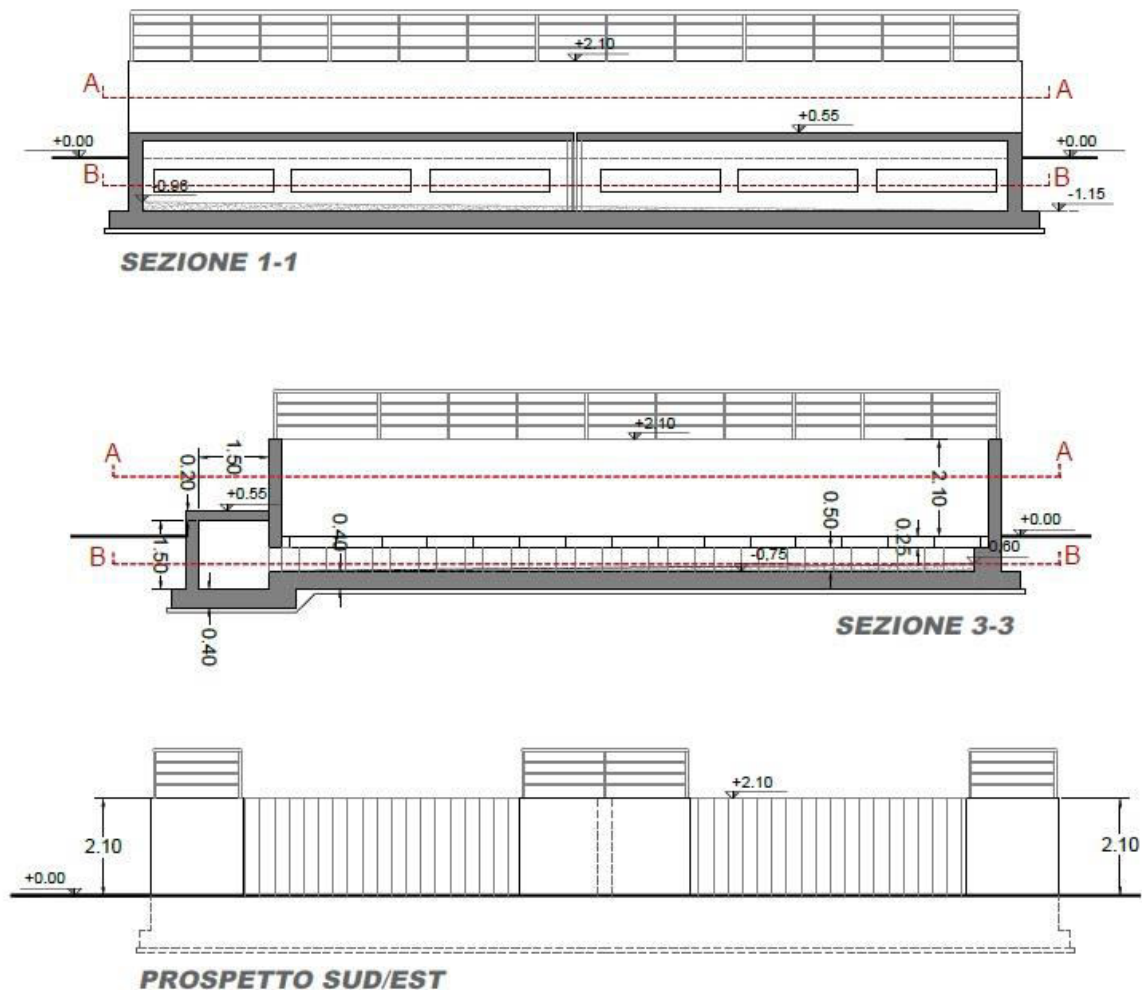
PROSPETTO PRINCIPALE e SEZIONI – Nuovo Biofiltro e "scrubber"
